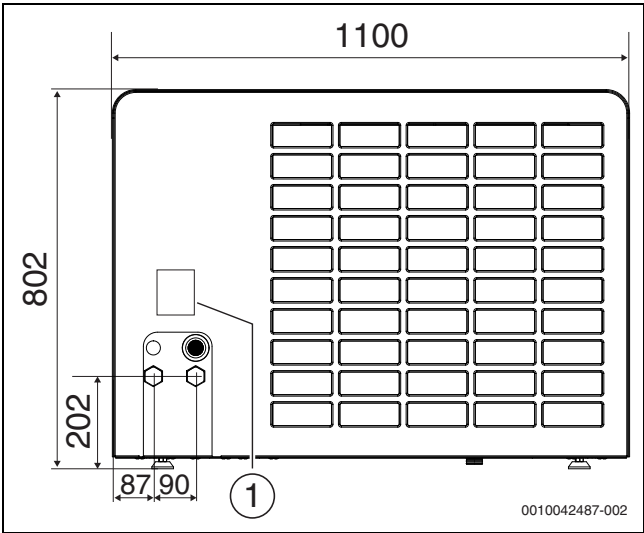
Dimensions et raccords de la pompe à chaleur, arrière
